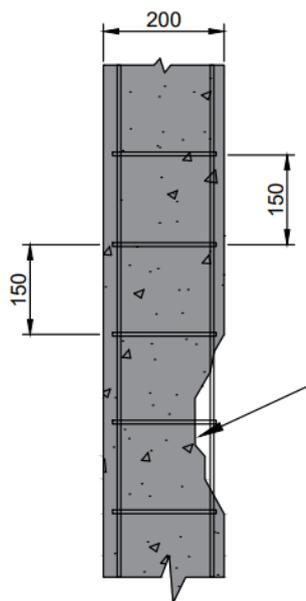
Esquema de fisuras verticales y horizontales en paredes de bloques de hormigón [Autores] (Unidades: mm)
